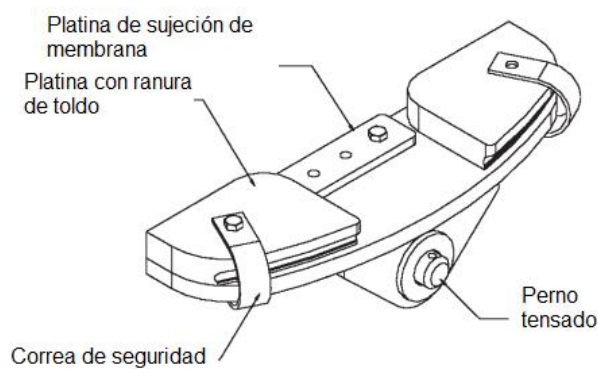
Detalle de conexión en las esquinas (Cerrado)
